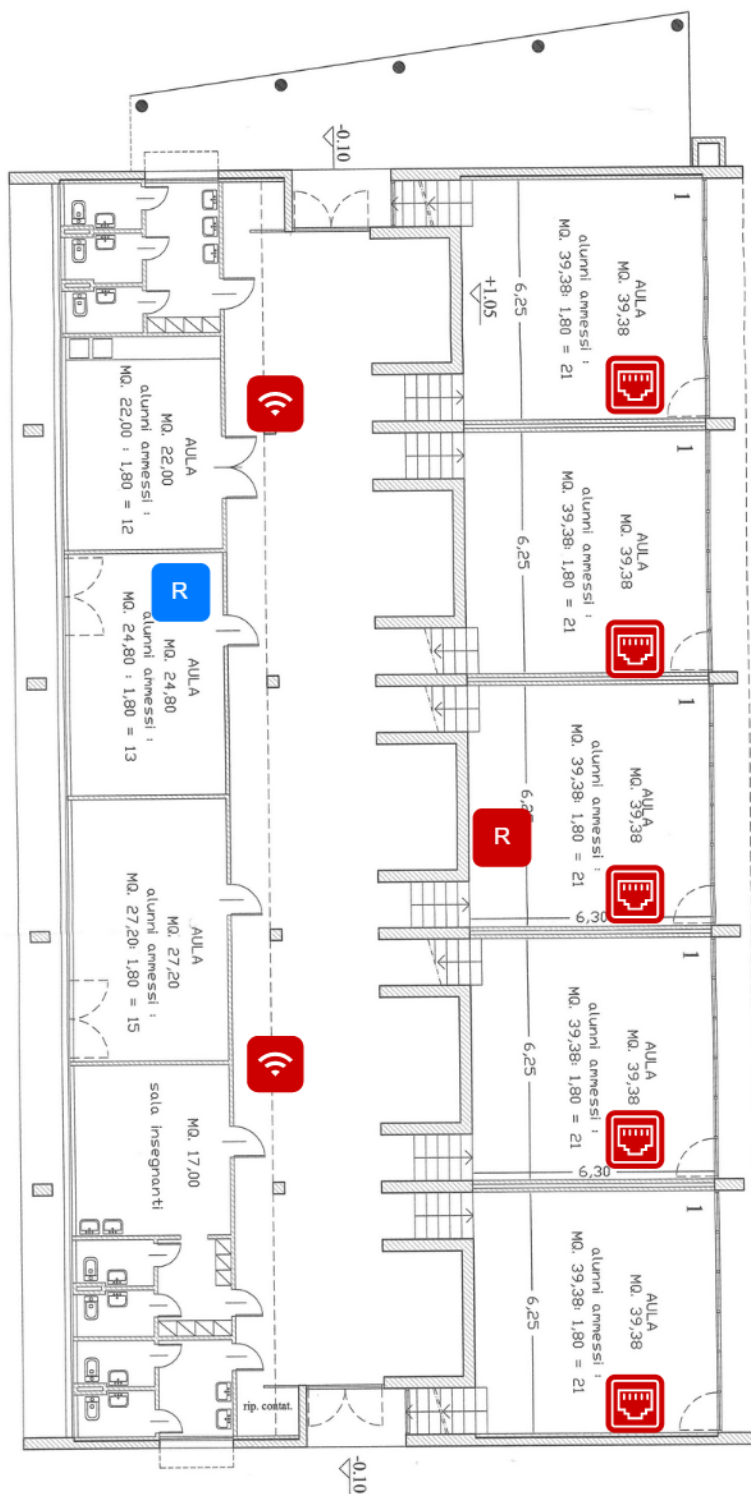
Planimetria Scuola Primaria "G. Rodari" - Piano terra
